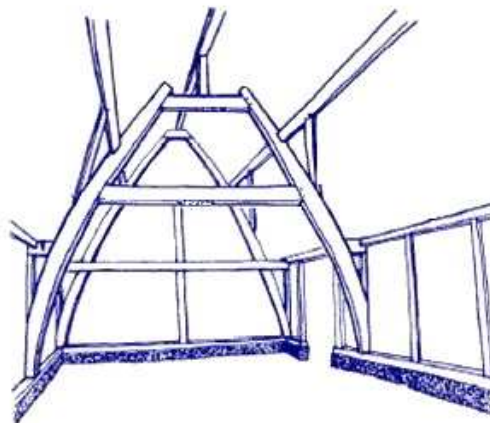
Estrutura tipo de uma construção de estrutura em A (cruck frame) [2.18].
